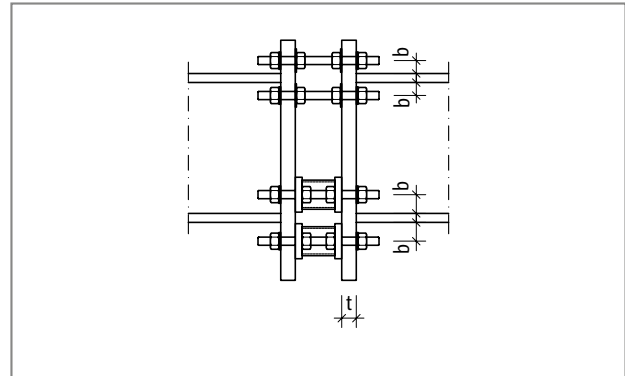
Plaque frontale T type S : tableau des entrées ; coupe
